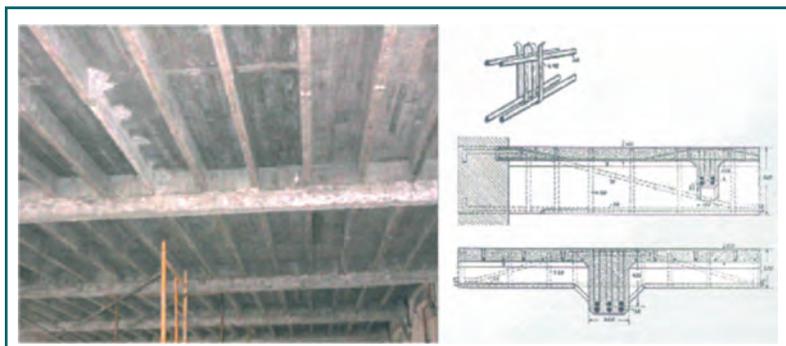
Viejas y aparentemente sanas estructuras: trampas potenciales (foto de los autores).
